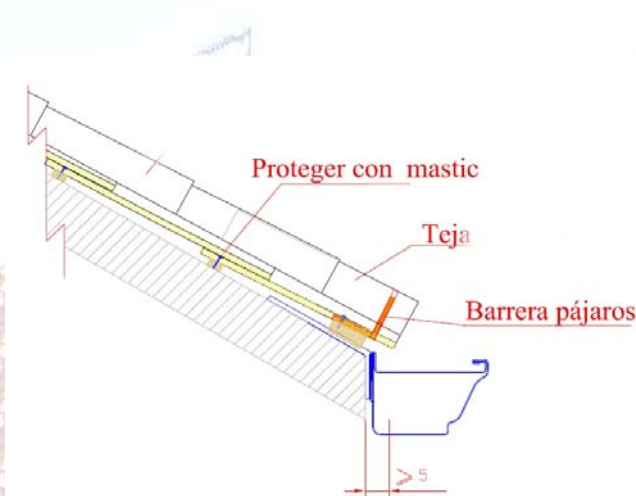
y Fotografía 24. Alero horizontal con canalón visto
